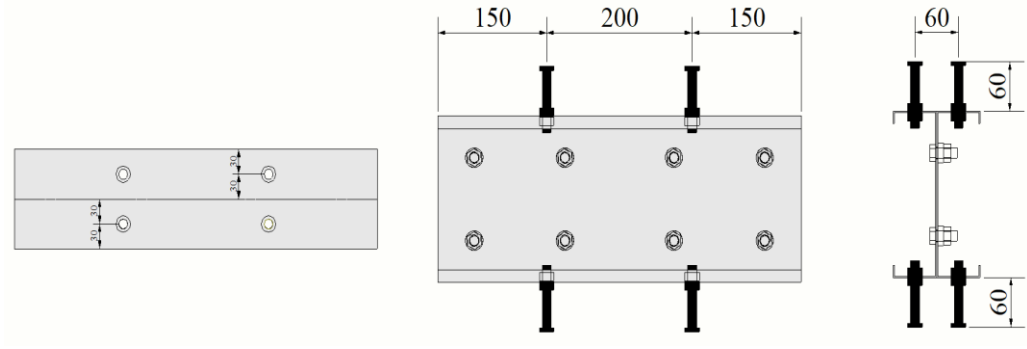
Hafif çelik kiriş boyutları (C200-1.5-15-60)
